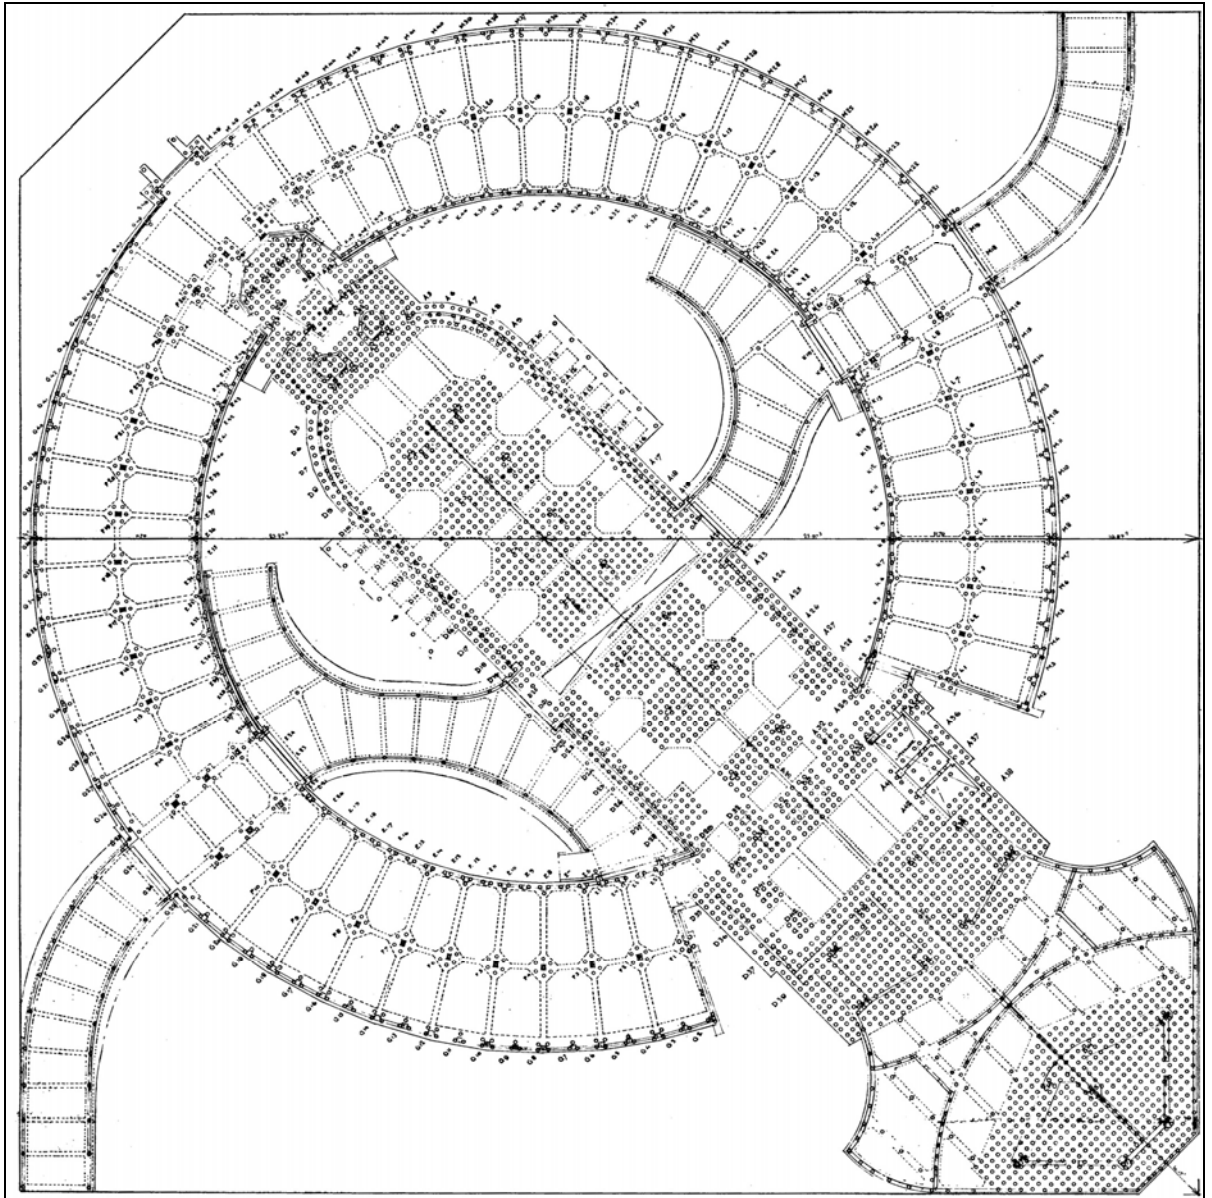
de schematische weergave van de betonconstructie onder de voorbouw en de hal. LIAG archief.
